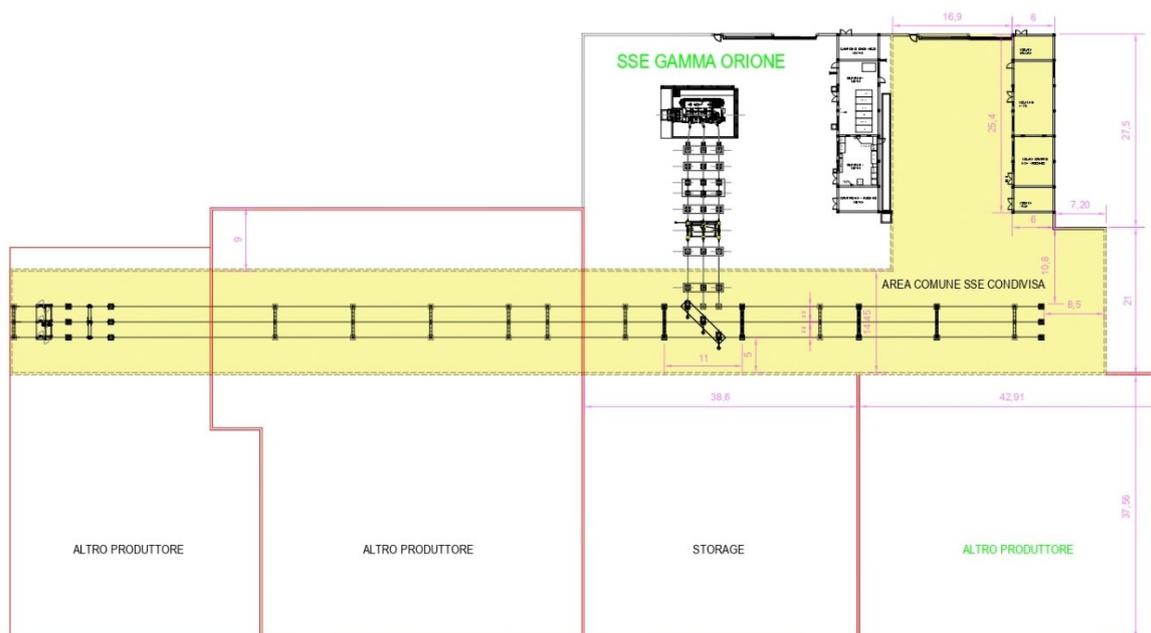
planimetria elettromeccanica Sottostazione Elettrica di Utenza della Società Proponente e delle Opere AT da condividere con altri Produttori
